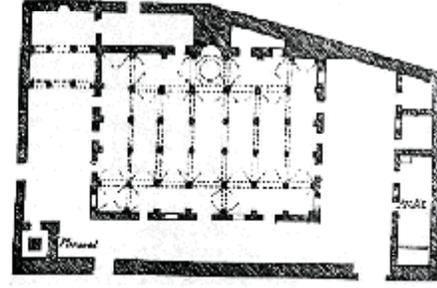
مسقط أفقي لجامع سيدي سليمان بتونس
